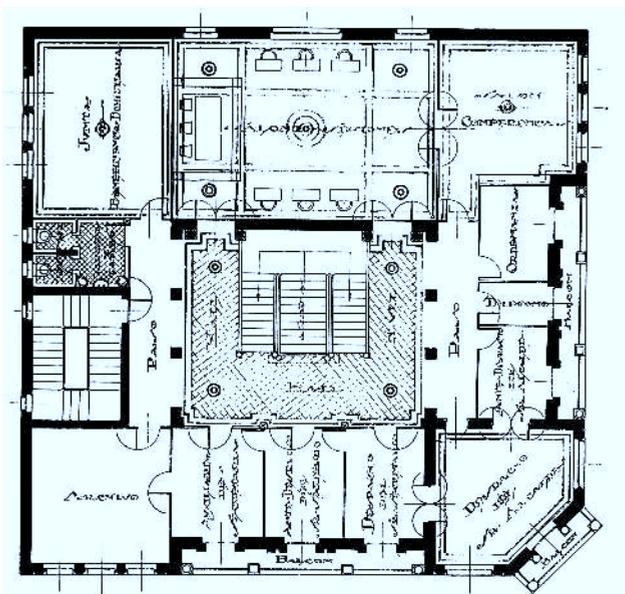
Proyecto para el Ayuntamiento de Carranza realizado en 1924 por el arquitecto Julio Sáenz de Barés. Planta del primer piso. (Edificio no construido).
